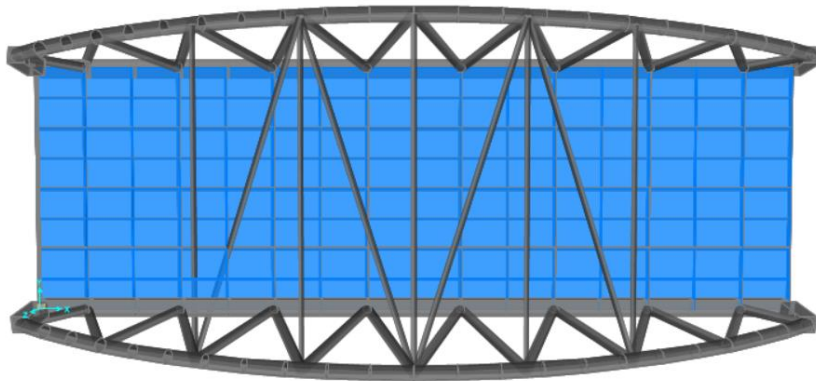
Planta de la pasarela tipo Warren en arco. (Fuente: elaboración propia en SAP2000).
